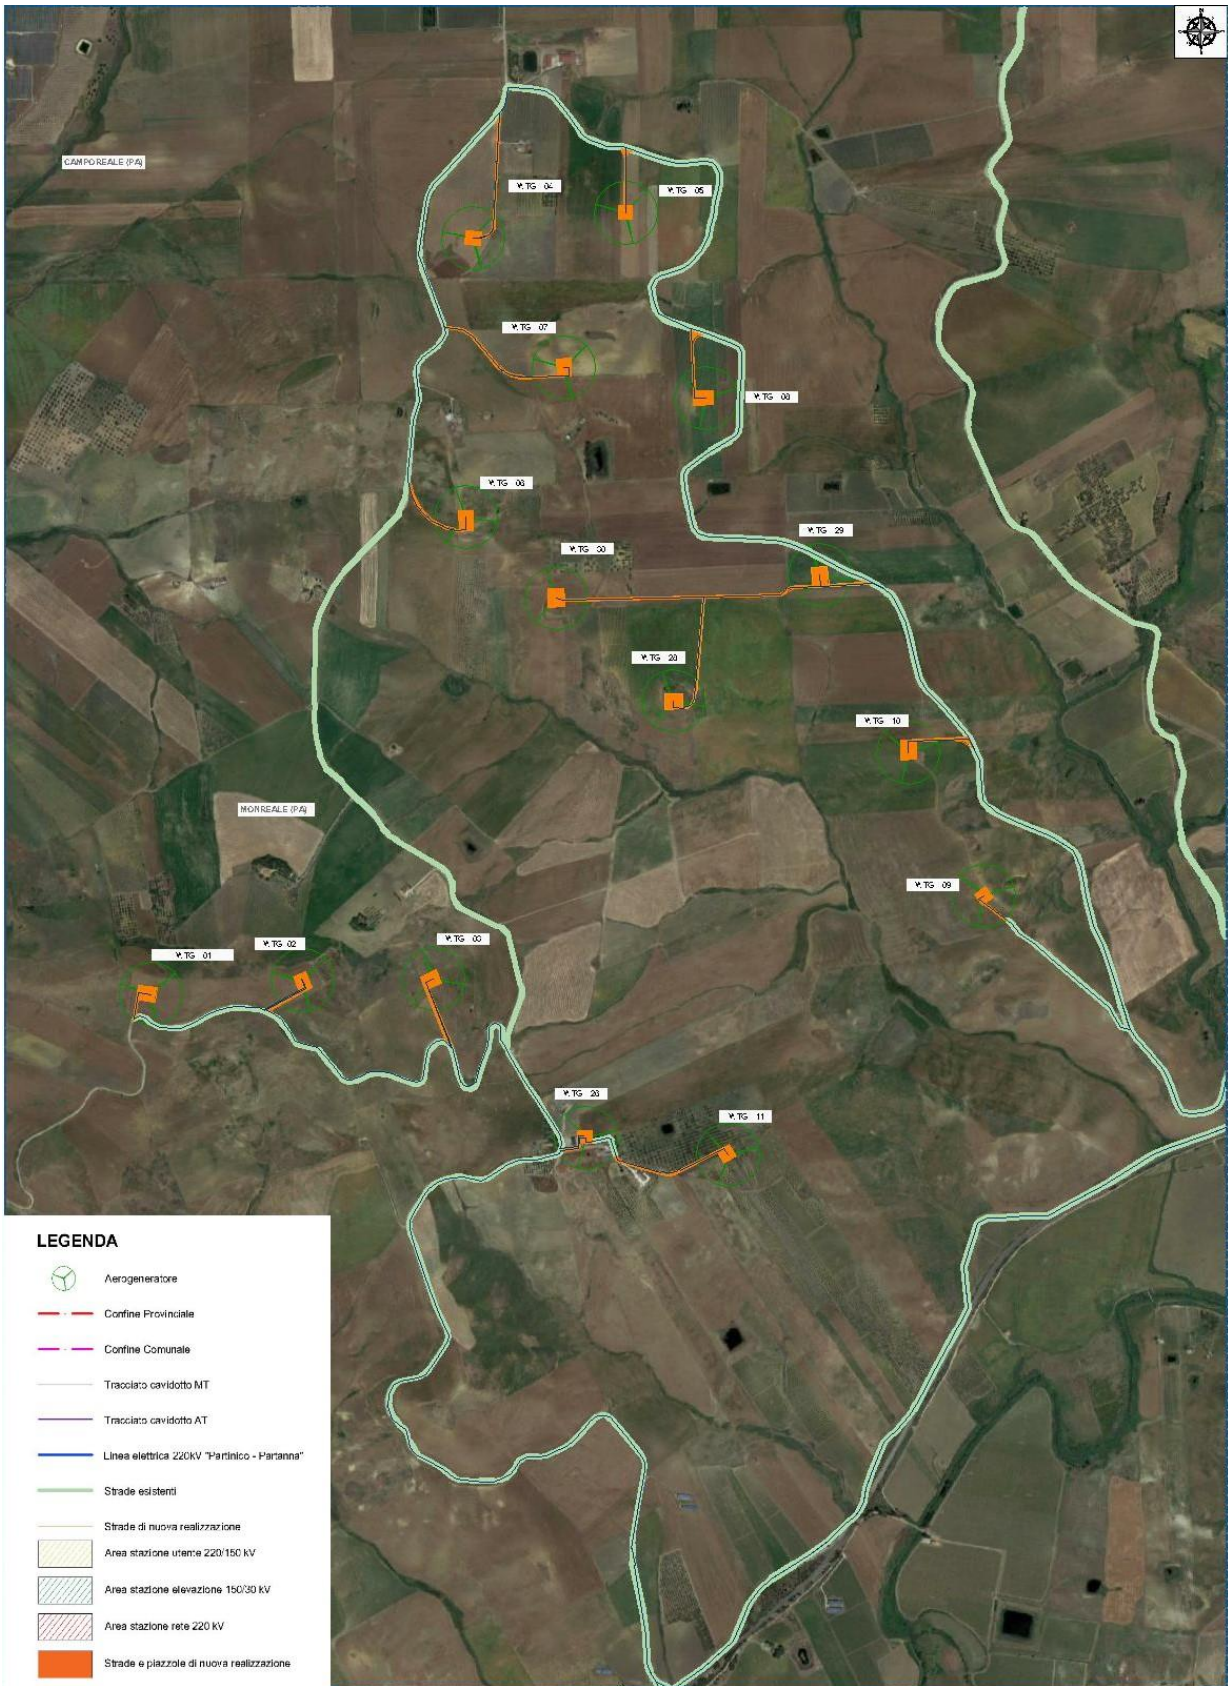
D - Ortofoto dell'area di impianto ricadente in Contrada Parrino e Pitarre
